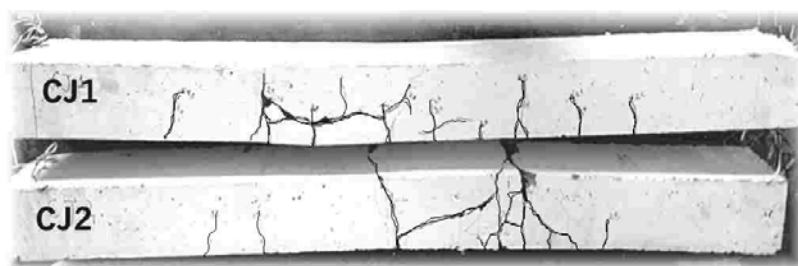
Vista lateral das vigas *CJ1* e *CJ2*.
